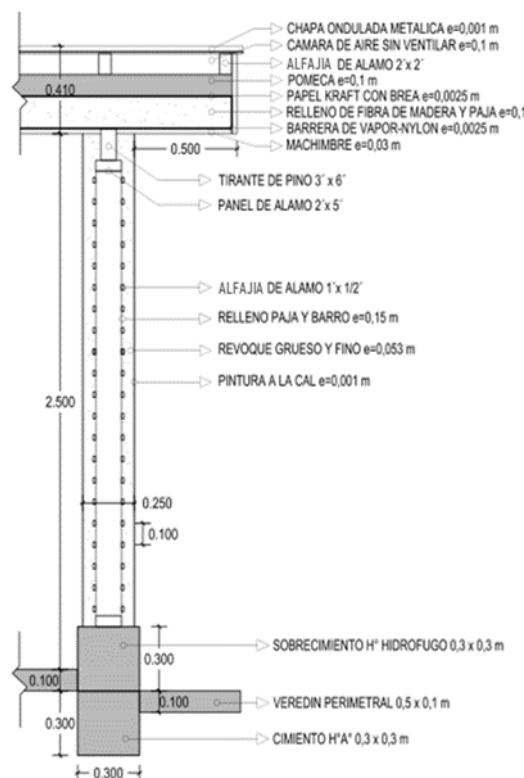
Detalle Constructivo de panel de quincha liviana seca, cerramiento lateral y superior
